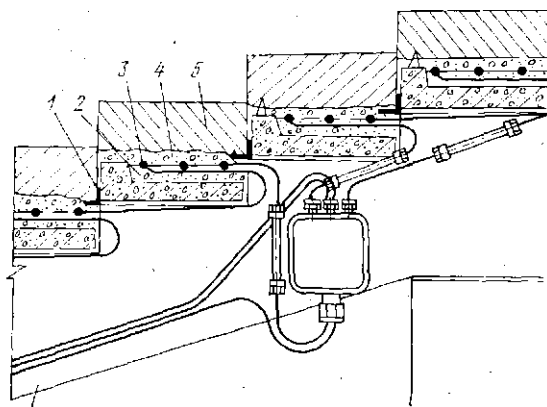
Электрообогрев лестничных переходов с помощью нагревательного кабеля.
